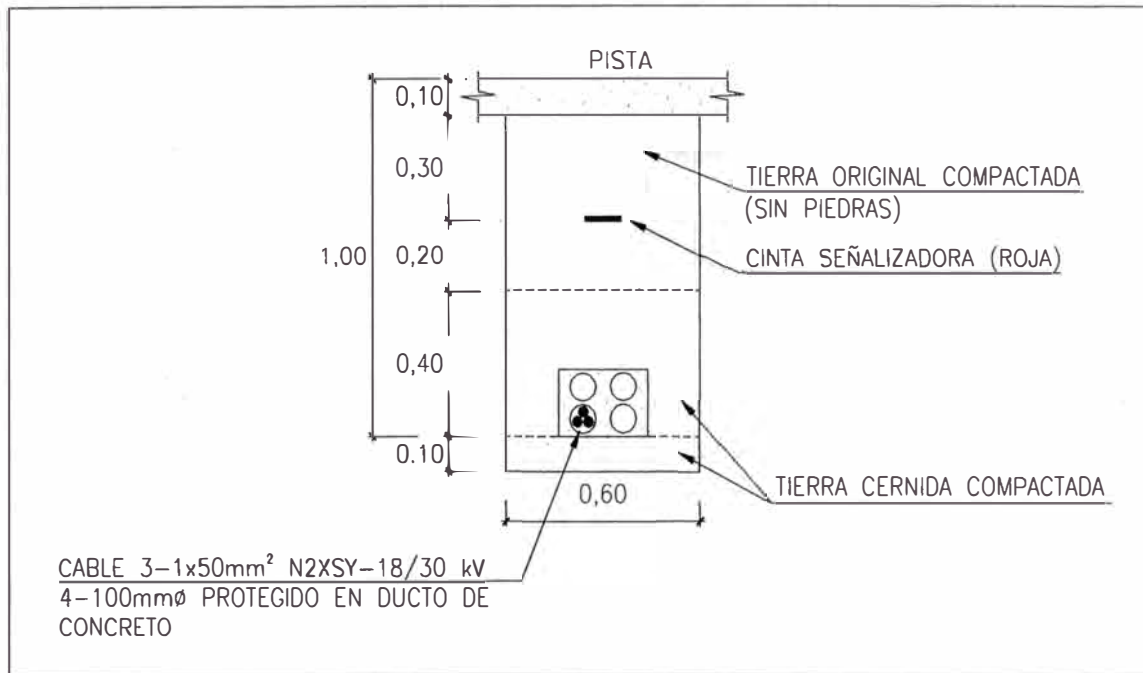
Detalle de instalación de cable bajo pista (corte B-B).
